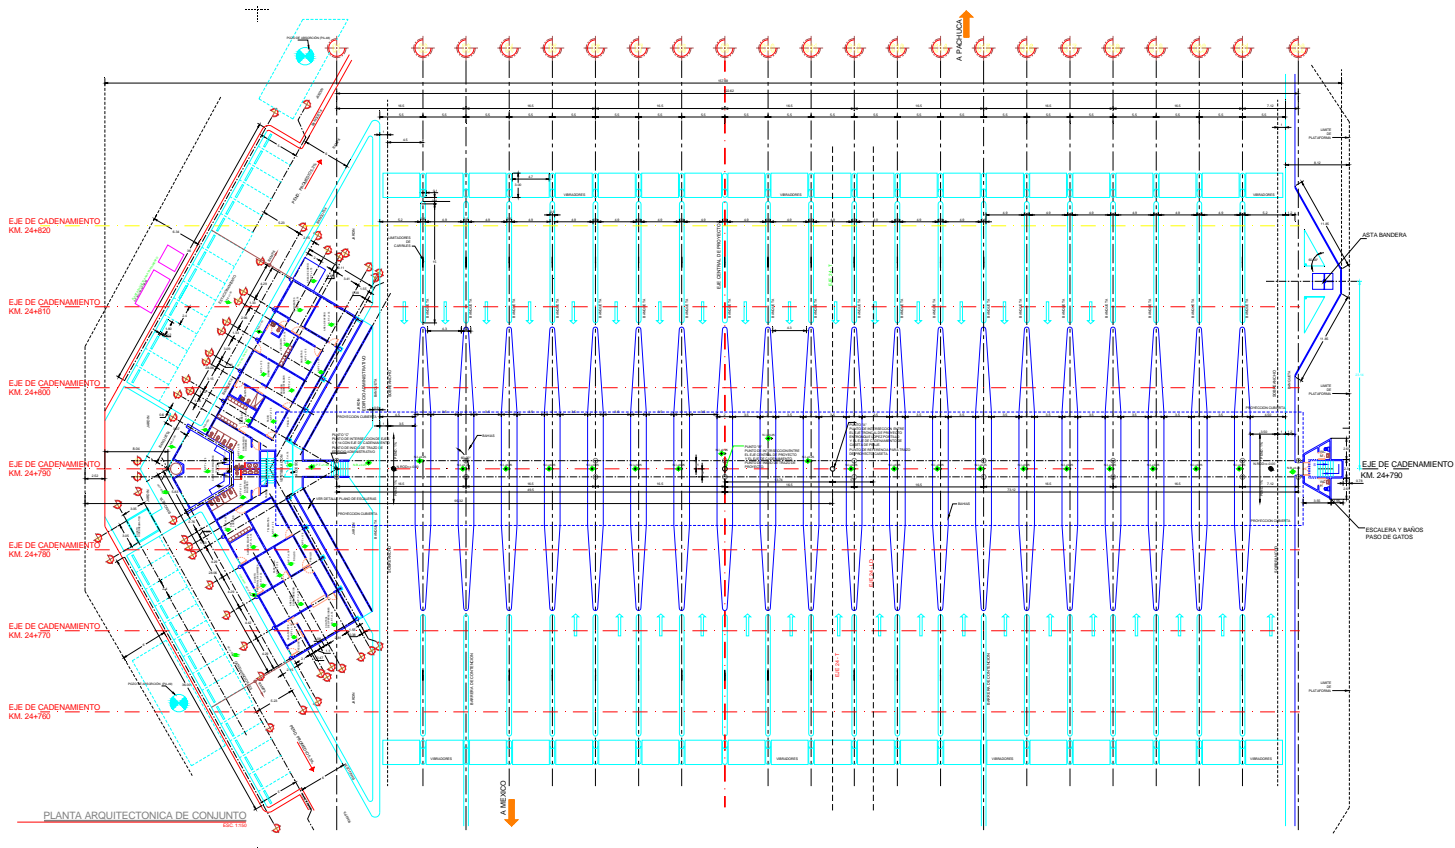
Planta Arquitectónica Caseta Ojo de Agua.
